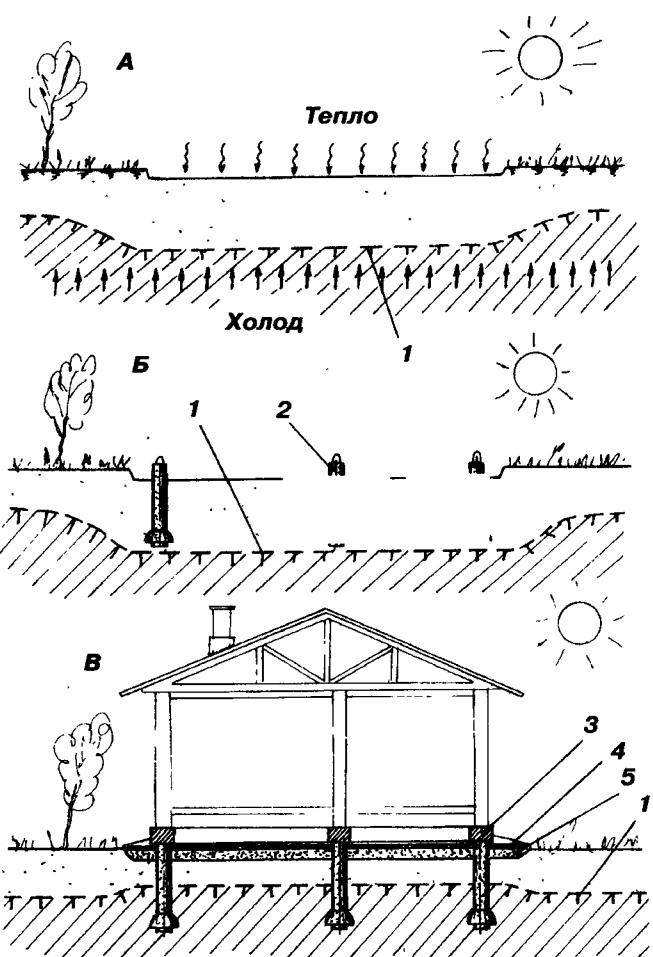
Создание фундамента в условиях вечной мерзлоты: А – снятие плодородного слоя; Б – создание опор фундамента; В – дом на вечной мерзлоте; 1 – граница оттаивания; 2 – опора фундамента; 3 – ростверк; 4 – слой утеплителя; 5 – песчаная подушка
